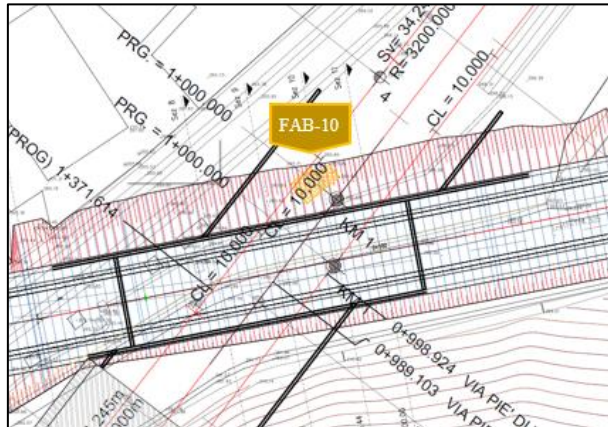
Stralcio planimetrico zona via Pie' di Virgolo
